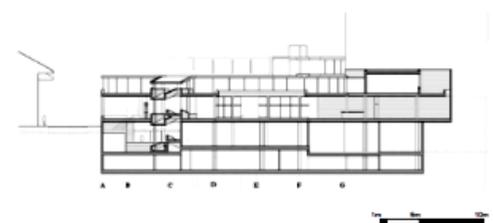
Corte C. Fuente: Los planos del proyecto, son cortesía del archivo de planos de
